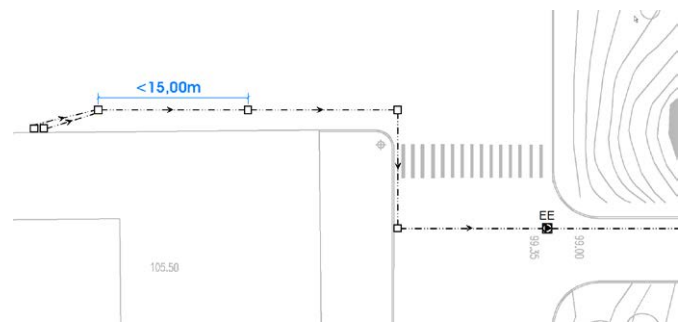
Exemplo de planta de rede de drenagem de águas residuais.
